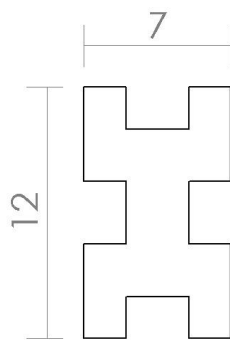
Perfil columnas estructurales 12 cm x 12 cm alternativa 2
